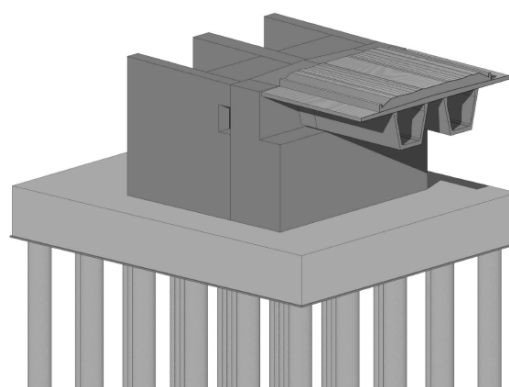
Modelo 3D del estribo fijo con contrafuerte central
